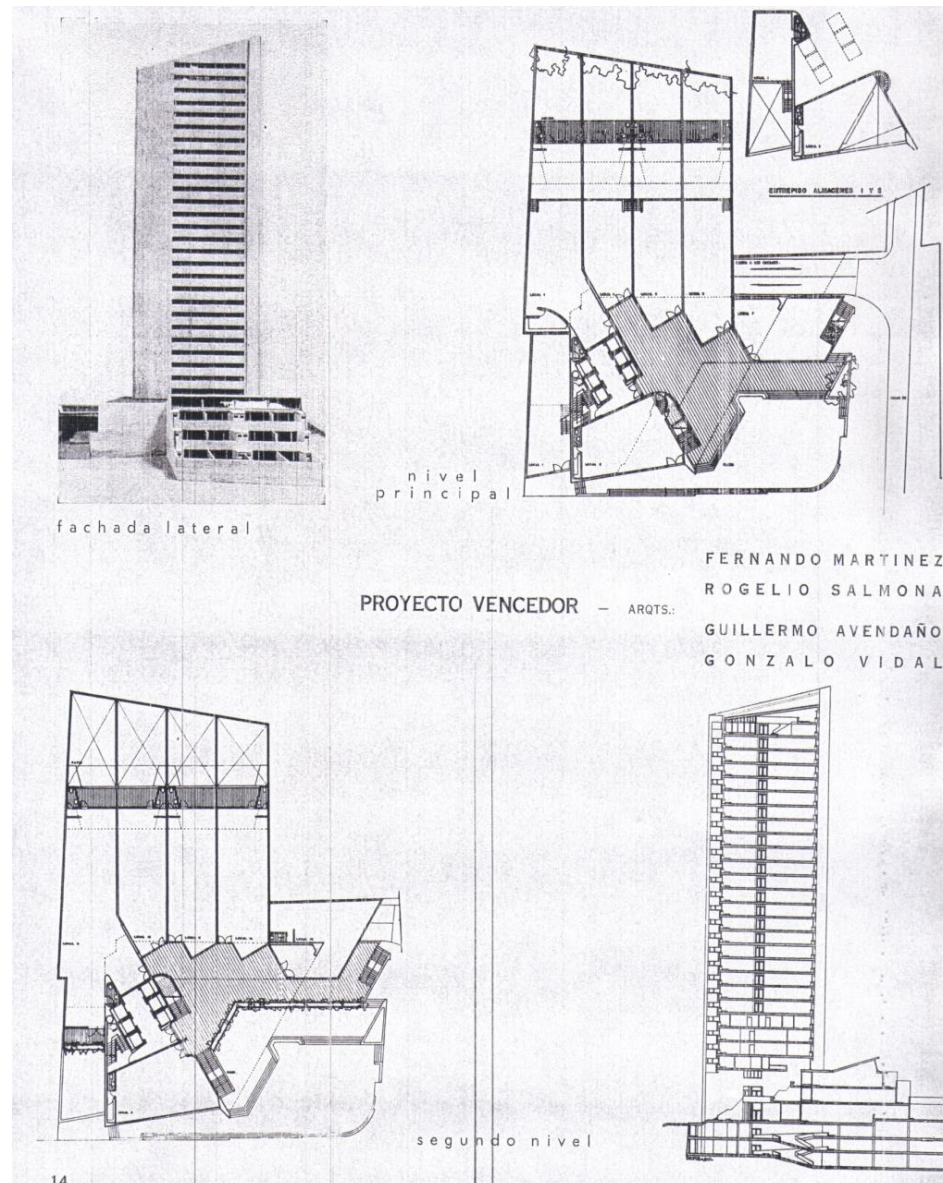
Plano de la fachada lateral Figura 5.1-2. Planta de nivel principal. Figura 5.1-3 planta del segundo nivel Figura 5.1-4. corte del proyecto ganador del concurso, Fondo de Empleados PONAL. Fuente: REVISTA PROA. Compendio de publicaciones. Bogotá, D.C.: Proa, 1963.
